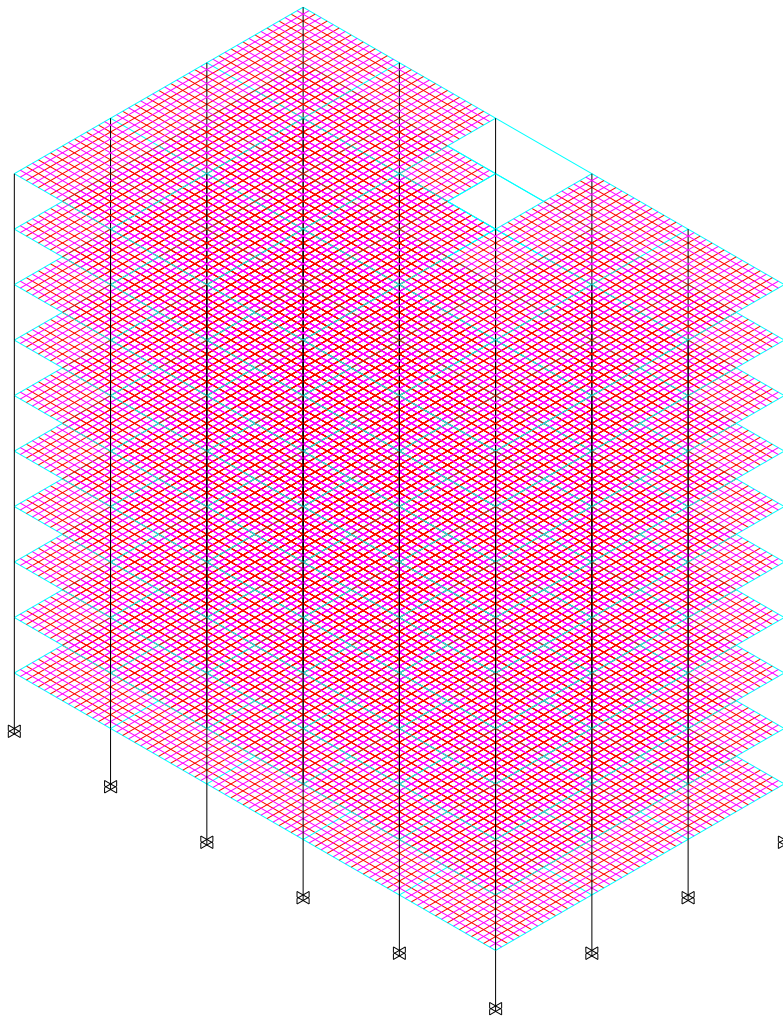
Modelo tridimensional de pórtico espacial com os dez pavimentos do edifício do projeto.
